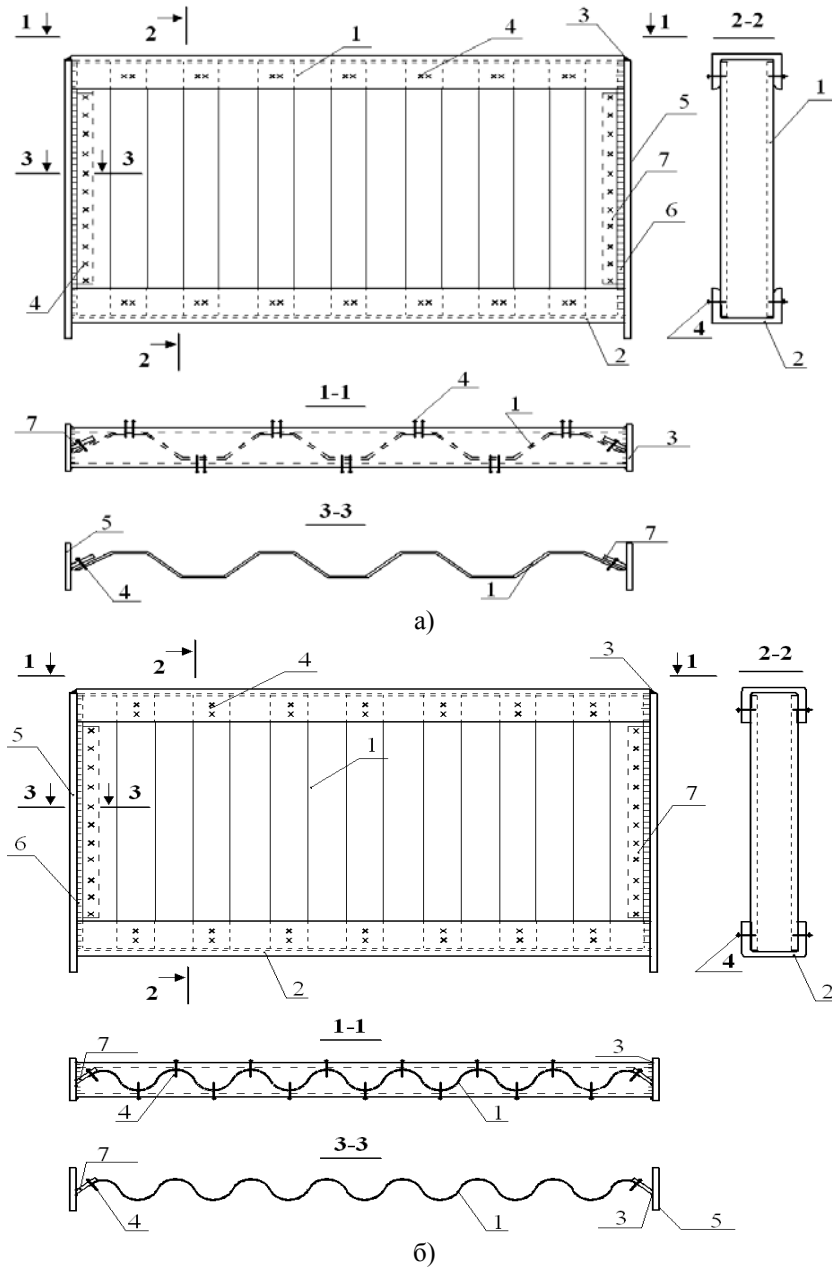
Балка з поперечно профільованою стінкою з поясами із швелерів на самонарізних гвинтах:
